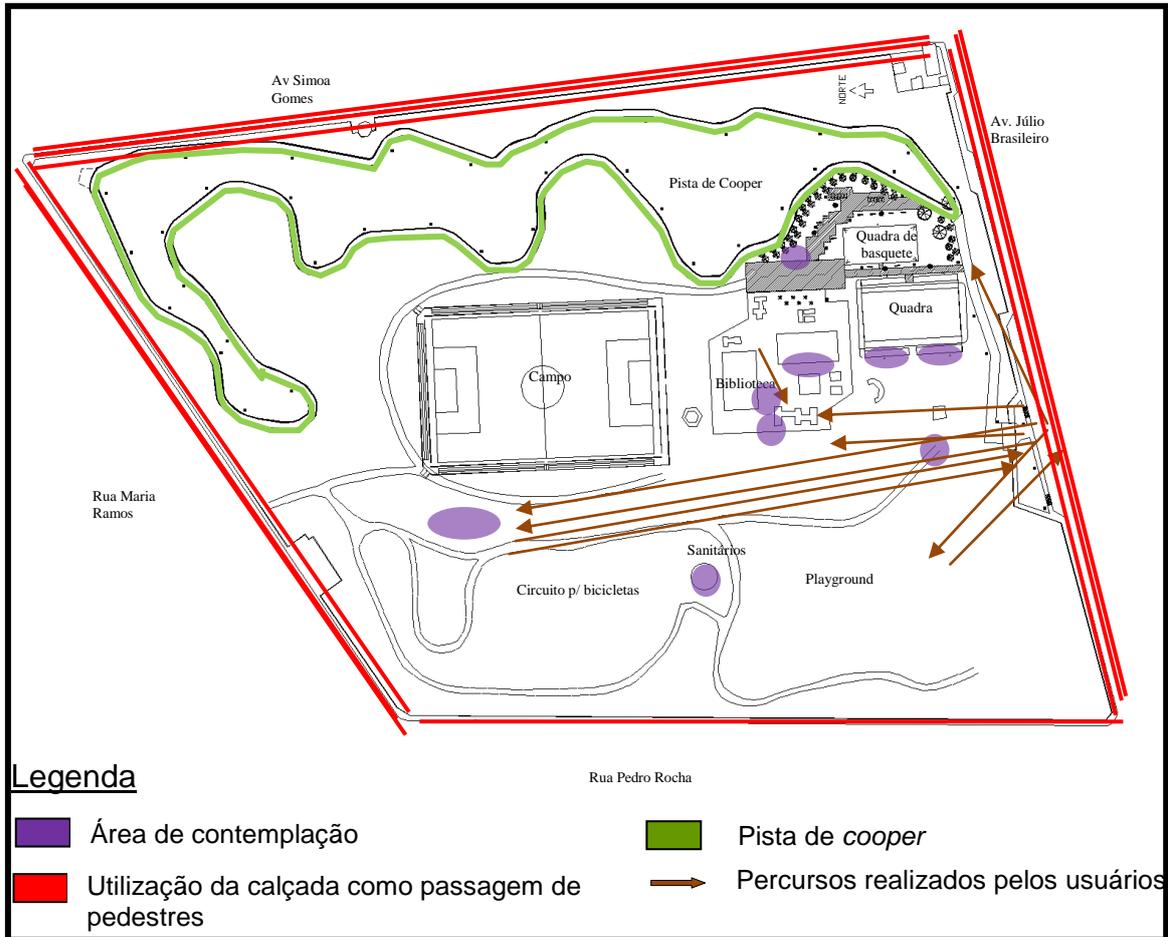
Planta Baixa da Academia da Cidade de Garanhuns.
